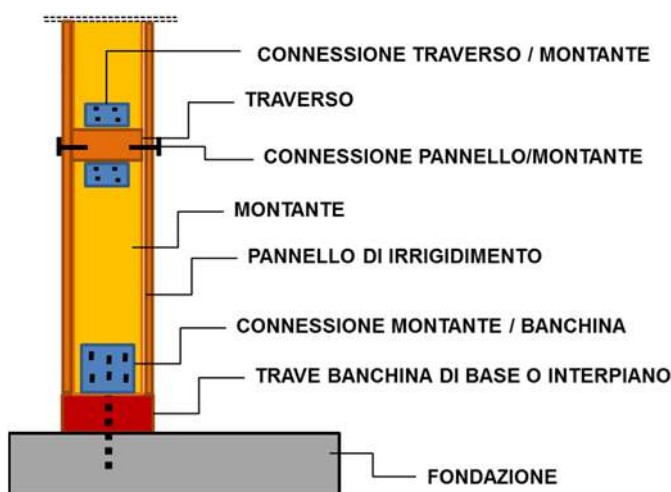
Dettaglio connessione di edifici a telaio leggero irrigidito: sezione verticale
